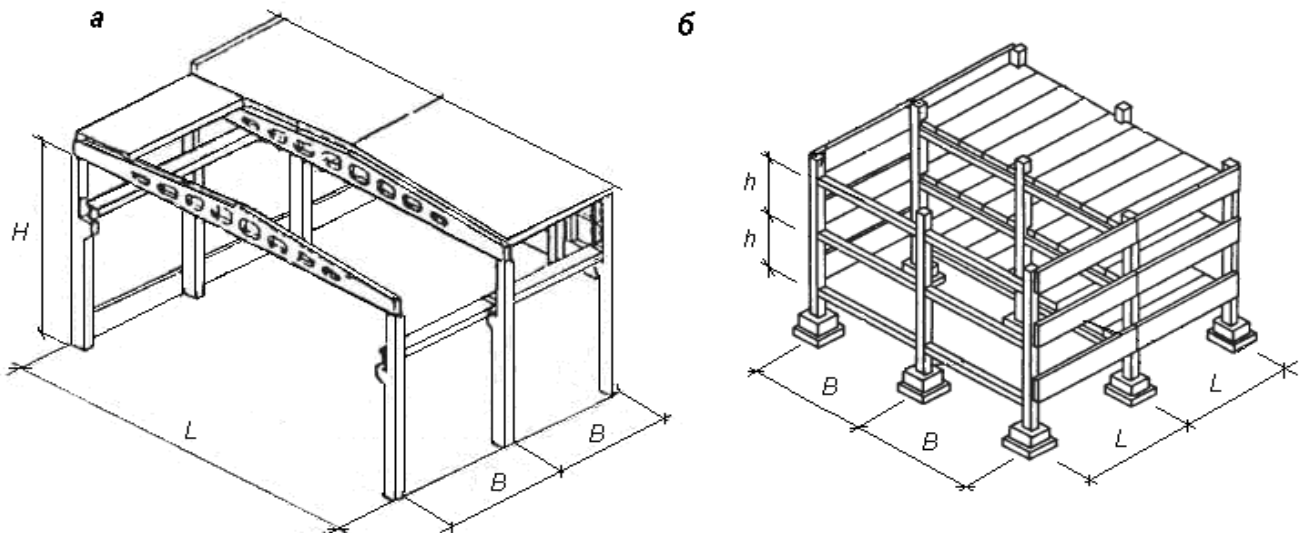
Основні параметри об'ємно-планувального вирішення виробничих будівель: а – одноповерхових; б – багатоповерхових; L – проліт; B – крок; H – висота одноповерхової будівлі; h – висота поверху
